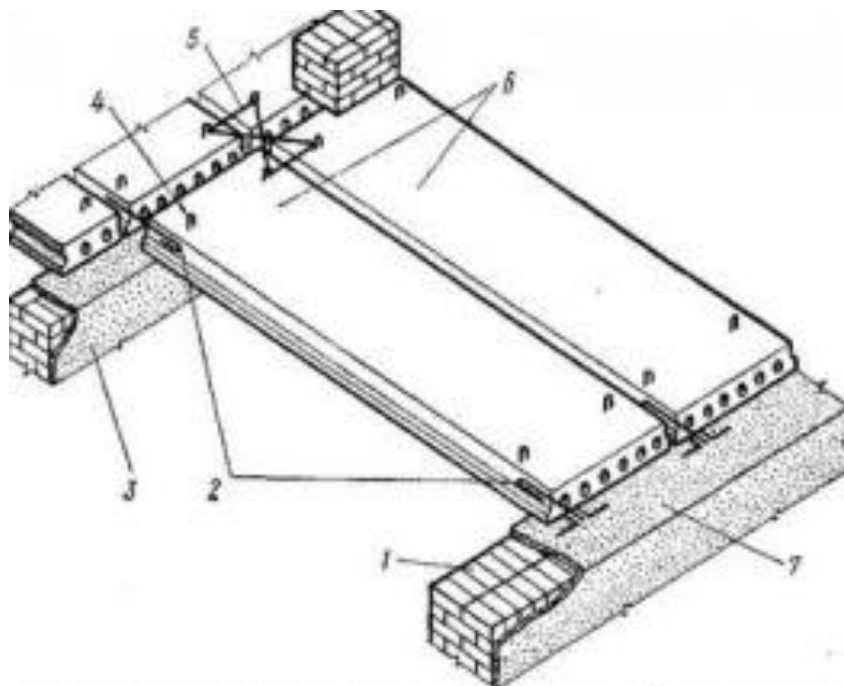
Перекриття із плит ПК: 1 – зовнішня стіна; 2 – сталеві анкери; 3 – внутрішня стіна; 4 – монтажна петля; 5 – скрутка із дроту; 6 – залізобетонні плити; 7 – зовнішня стіна
